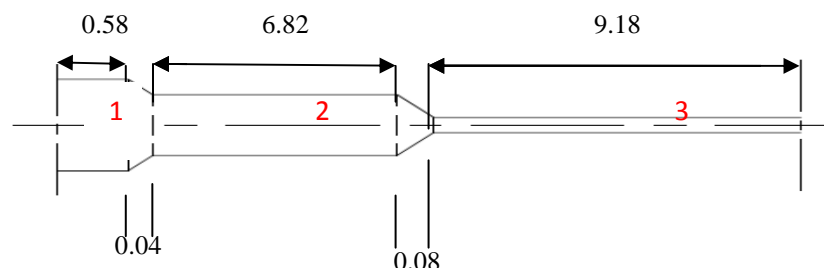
Les différentes sections qui composent la poutre en béton précontraint.
